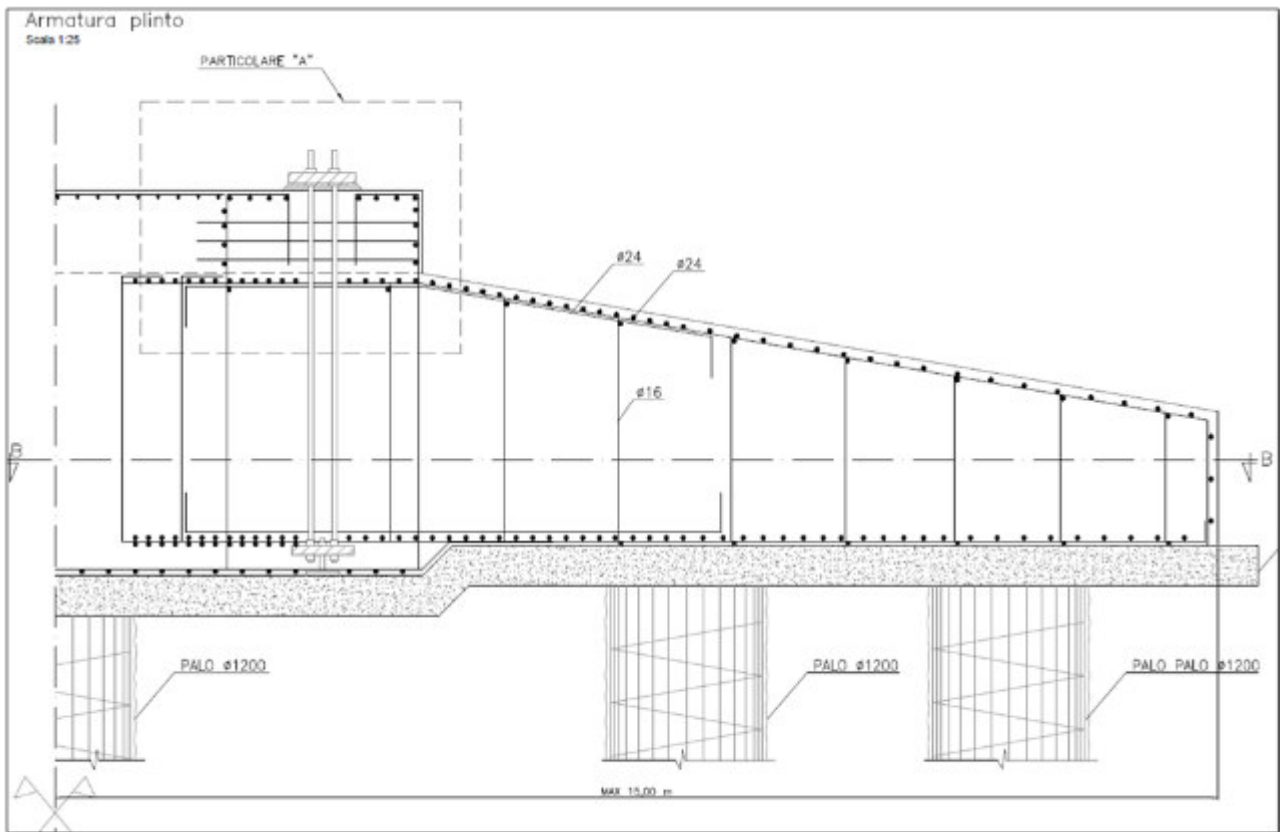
Sezione platea – armatura e sistema di fissaggio
